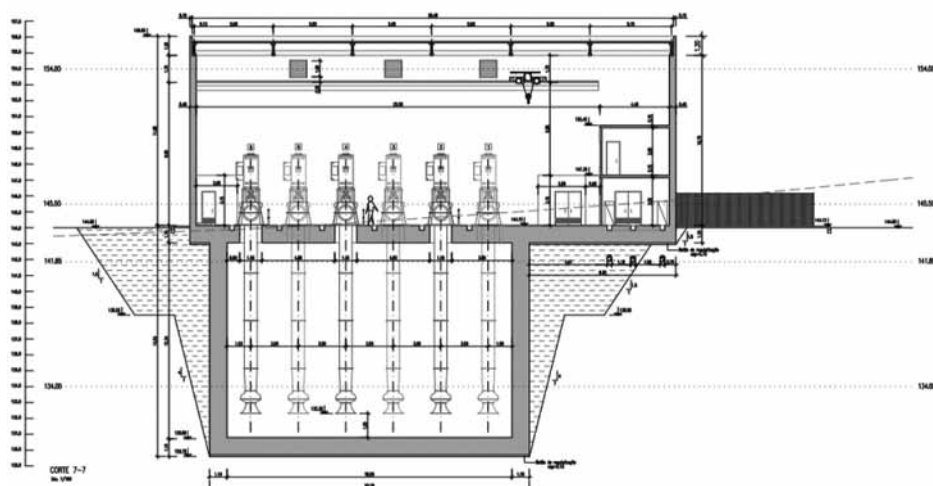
Estação Elevatória de S. Pedro. Corte Transversal
